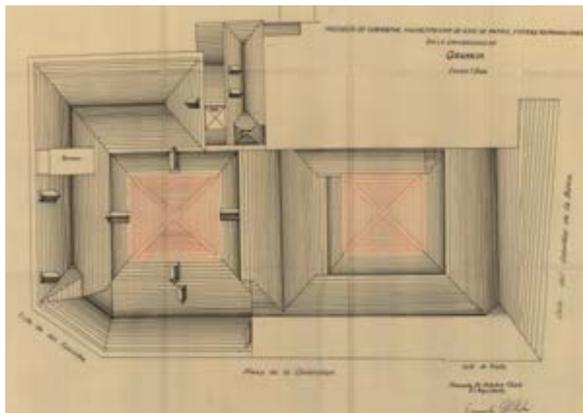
Fernando Wilhelmi Manzano, *Proyecto de reparación de cubiertas, pavimentación de ojos de patio y otras reparaciones en la Universidad de Granada*, planta, 1942, AGA.
